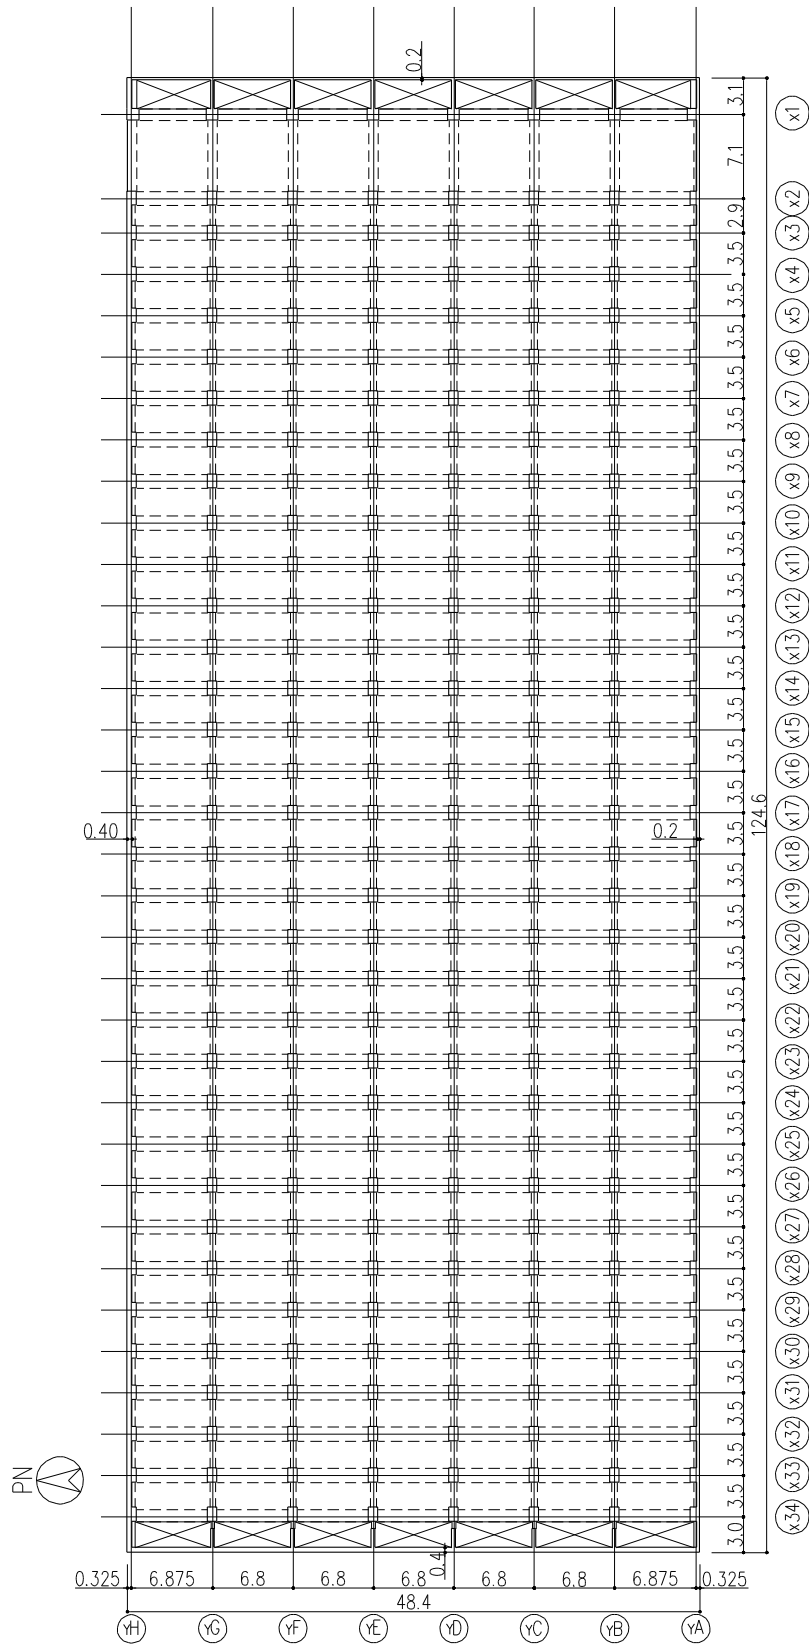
地下 2 階平面図 (G. L. -8.7) (单位 : m)
